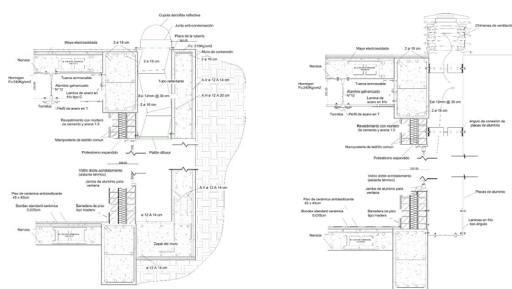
Detalle constructivo de tubos solares y torres de viento. Fuente: Elaboración propia
